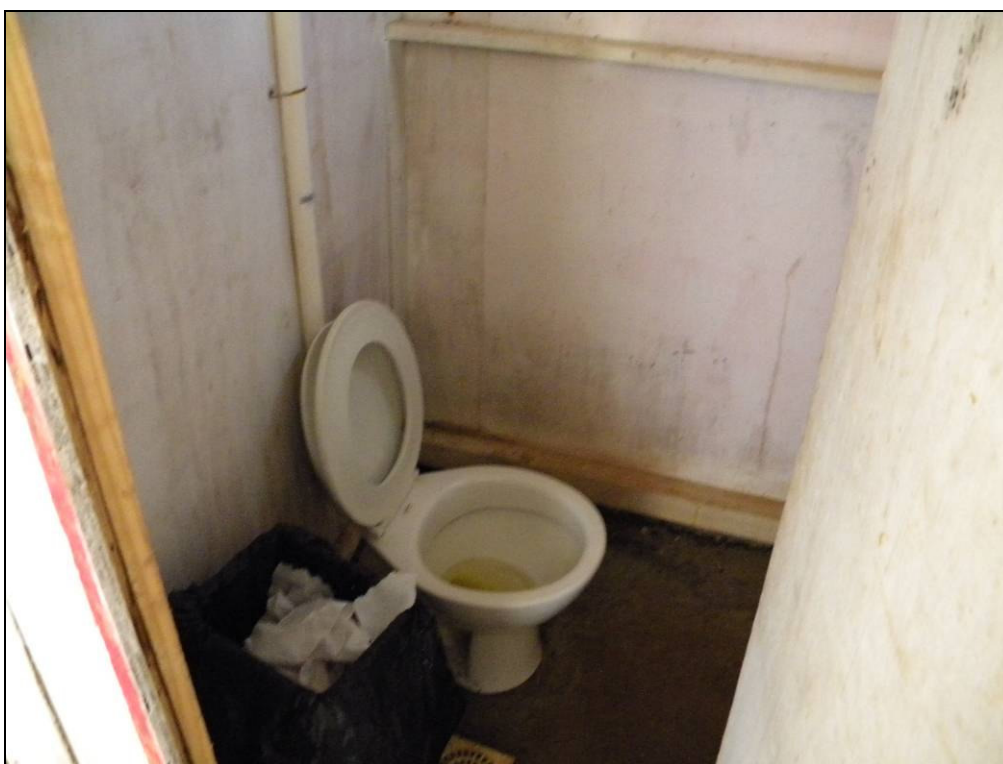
Banheiro da obra A (Obra pequeno porte)
